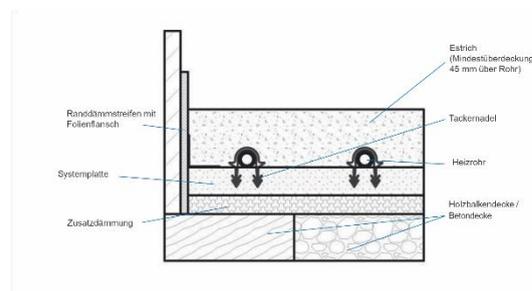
Aufbau der Bauart A einer Fußbodenheizung/-kühlung in Nassbauweise
